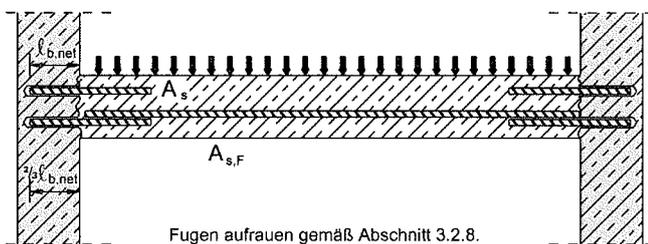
Bewehrungsanschlüsse überwiegend auf Druck beanspruchter Bauteile
